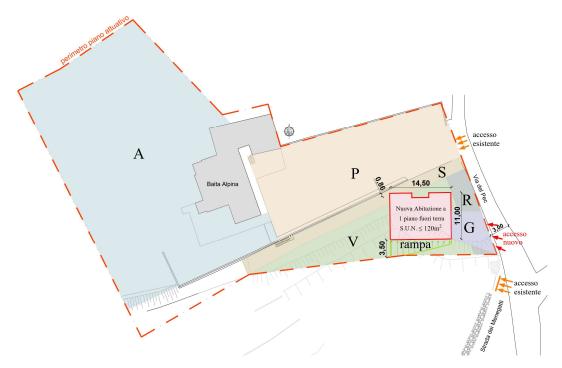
Soluzione inserimento abitazione in perimetro piano attuativo
